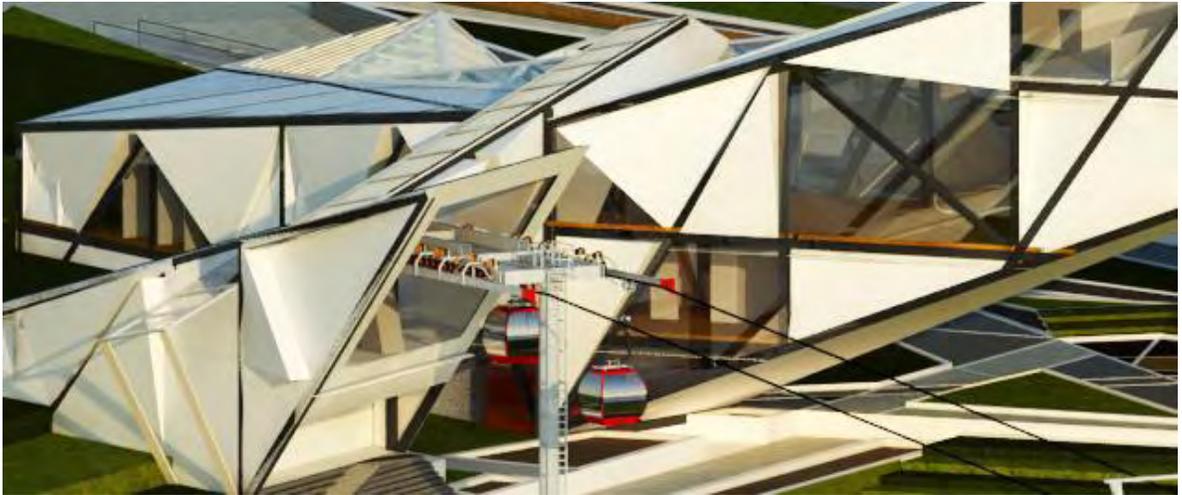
Modelo de fachadas. Fuente: Elaboración Propia
